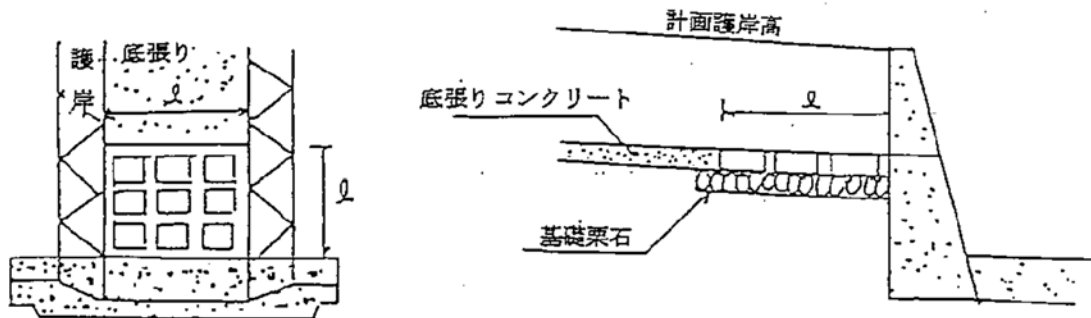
伏流水排除工 (底張ブロックの場合)
